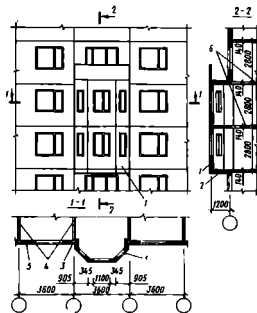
Конструкция эркера в новом поколении крупнопанельных жилых домов для Московского строительства:
